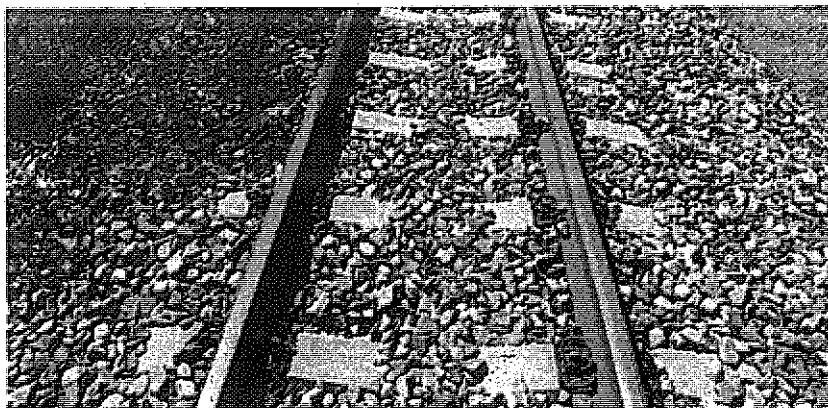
Superestructura de vía a continuación de los durmientes de Q"C\* existentes a cada lado del puente.
